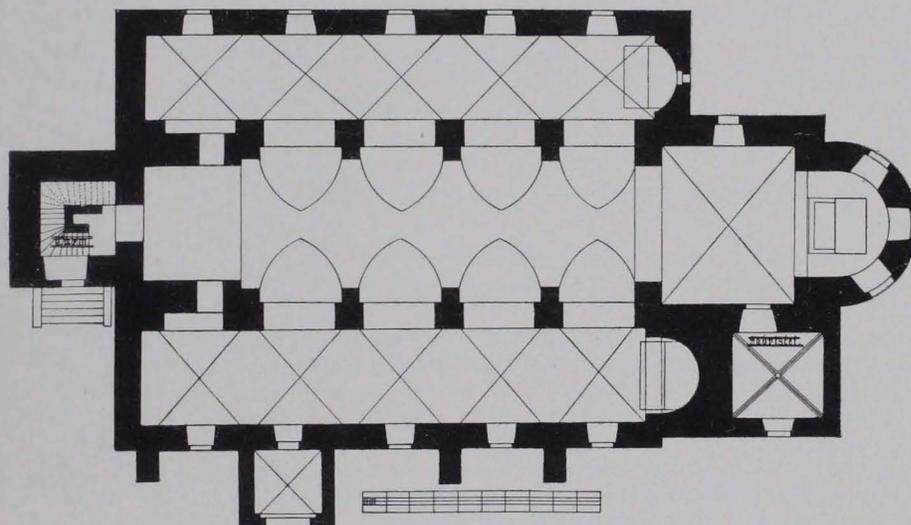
Weikertschlag, Pfarrkirche, Grundriß 1 : 300 (S. 108)
